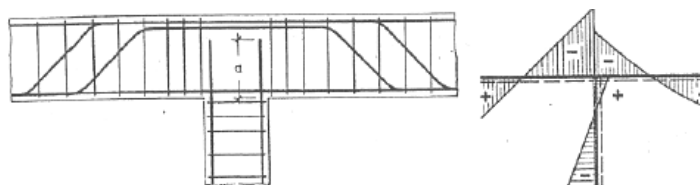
Detalle de Armado de Pilares Interiores con Momentos Bajos\
